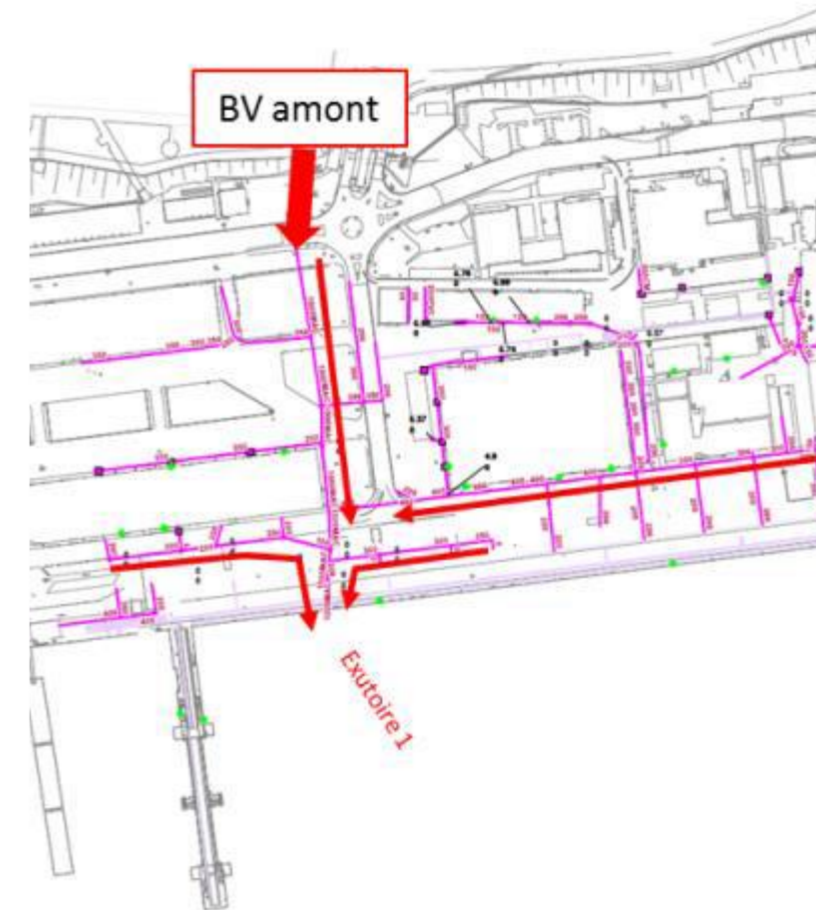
Réseau d'eau pluvial sur le site du projet de déconstruction
